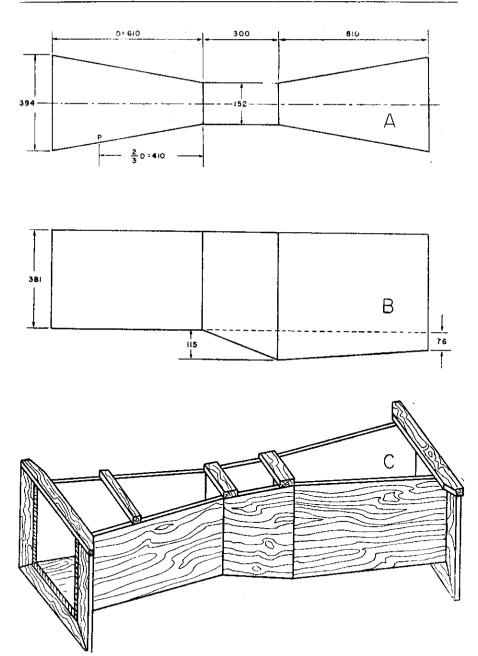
Desenho esquemático da calha medidora "Parshall" modêlo 1/2 A de Hardesty. A, vista de cima; B, vista de lado; C, perspectiva da calha construída de madeira.
